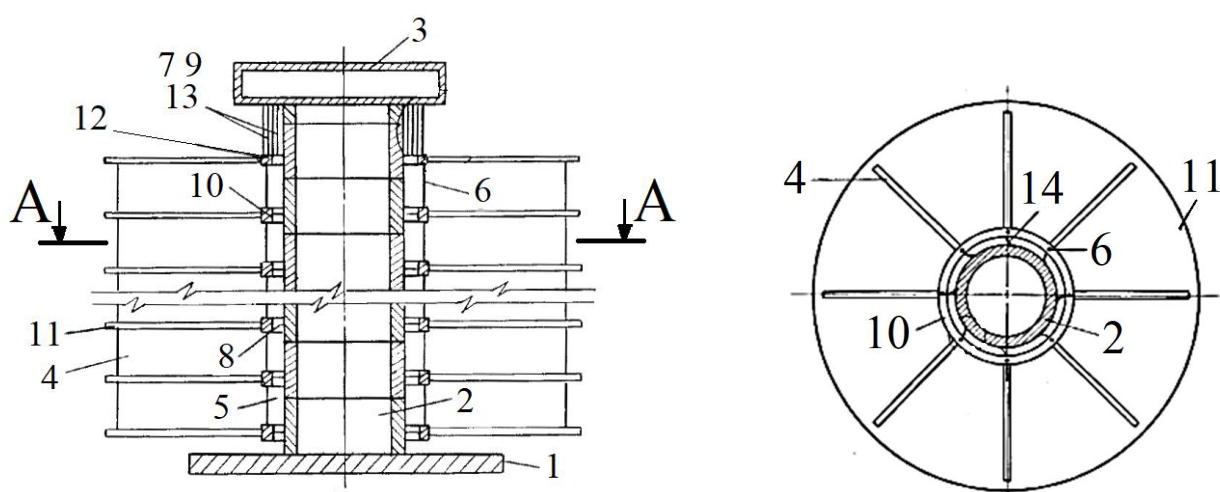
Многоэтажное сейсмостойкое здание: 1 – фундамент; 2 – ядро жёсткости; 3 – оголовок; 4 – конструкции этажей; 5, 9 – зазор; 6 – тяжи; 7, 8 – амортизирующие связи; 10 – замкнутые рамы; 11 – перекрытия; 12 – верхняя рама; 13 – подвески; 14 – изогнутые консольные стержни
